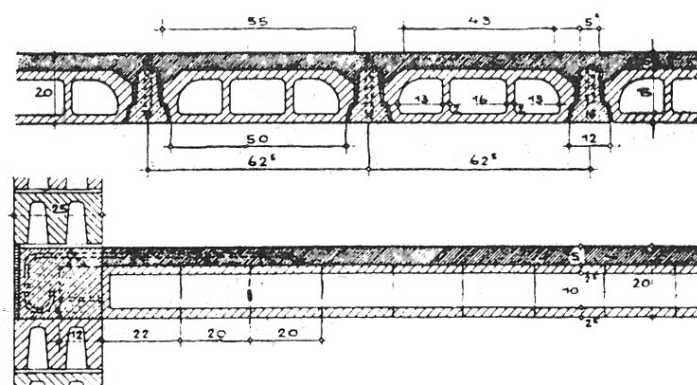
Ebenseer Hohlsteindecke mit Aufbeton 20cm Konstruktionshöhe [16]
